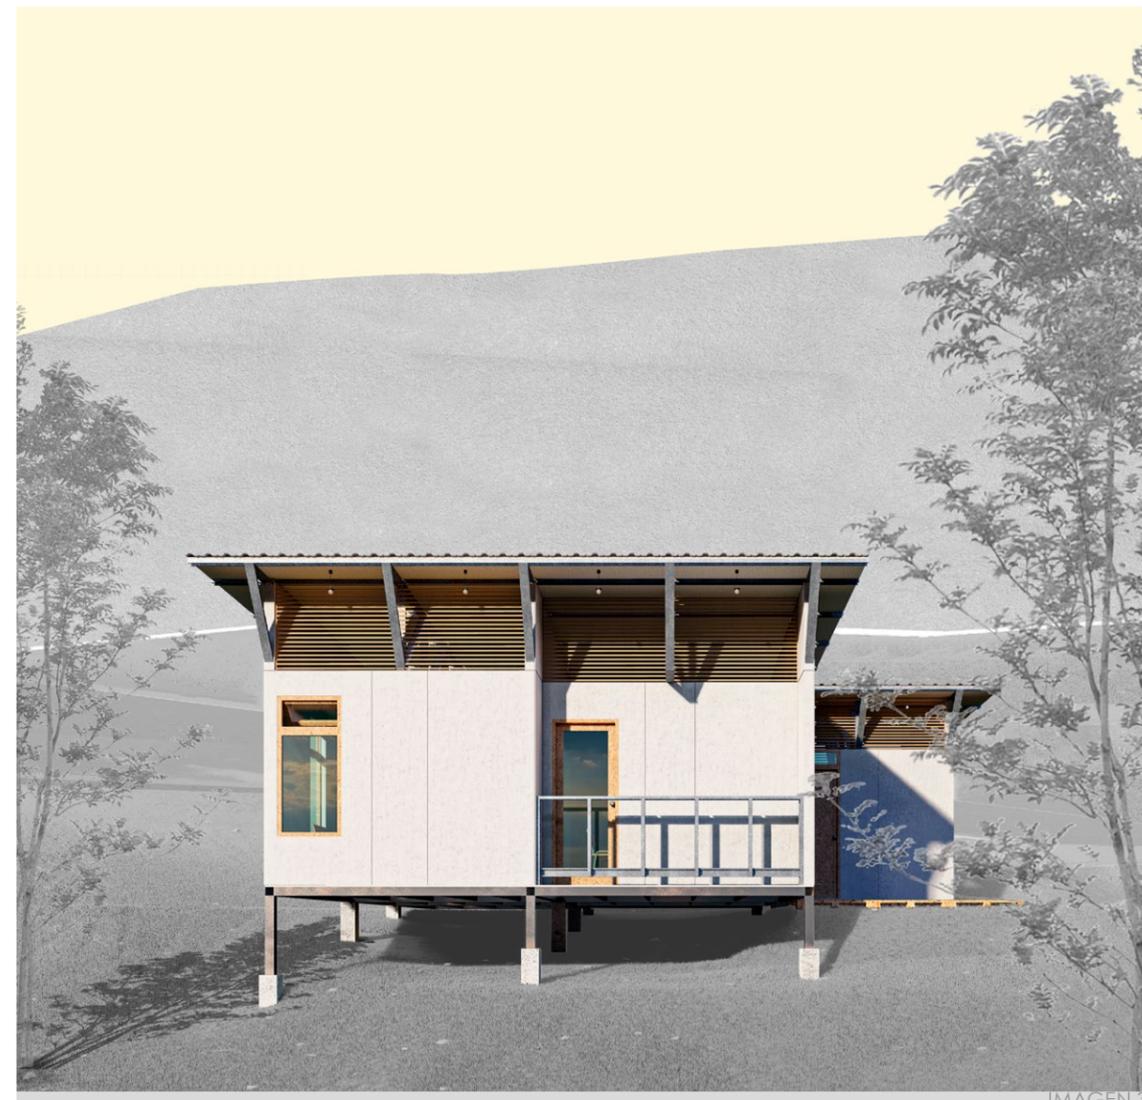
Render exterior #2 del proyecto "vivienda de apoyo".
